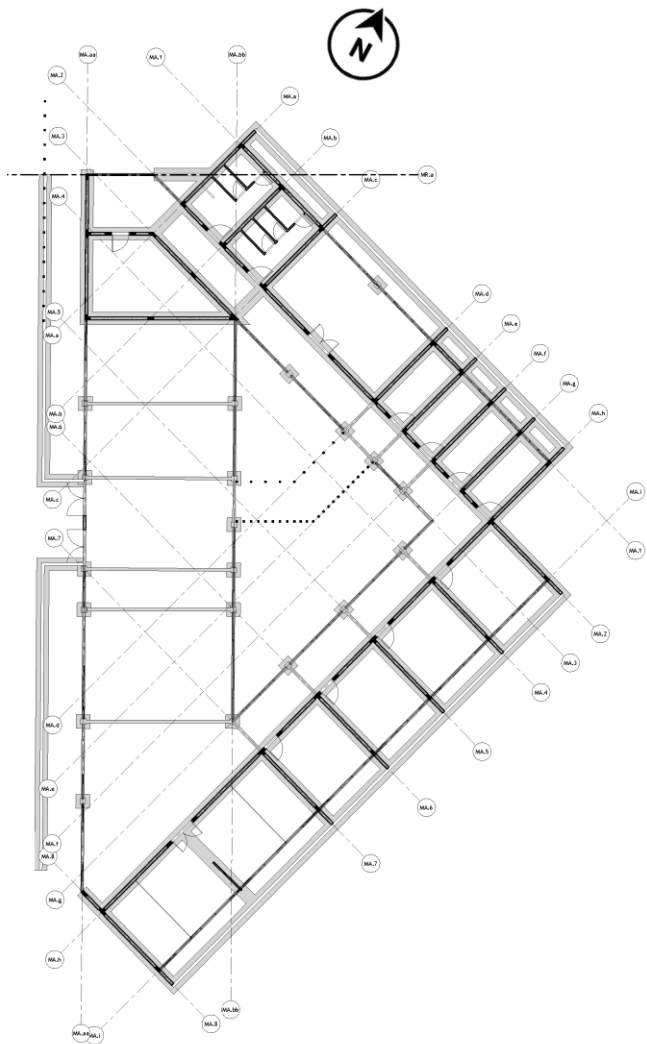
Planta de cimientos y columnas de urgencias - Elaboración propia, 2024
